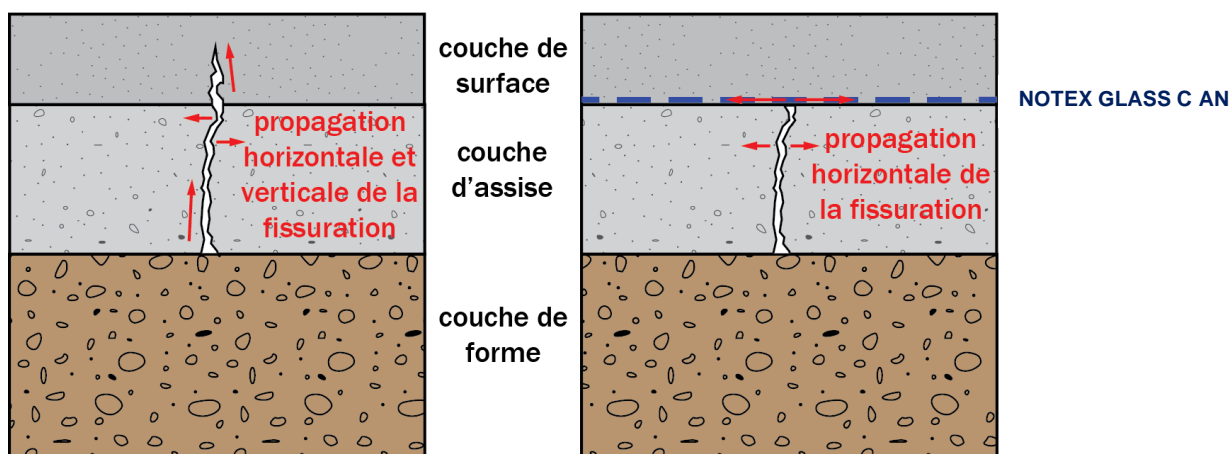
RETARDEMENT DE LA FISSURATION DANS LES COUCHES DE SURFACE GRACE AU GEOCOMPOSITE NOTEX GLASS C
